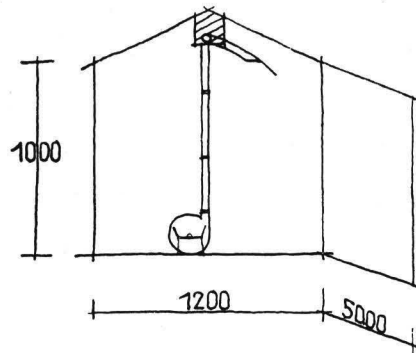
Gebläsehäcksler, Zerreißer und andere. Möglichst stationär an gut zugänglicher Abladestelle unter Dach. Förderung erst hoch, dann waagrecht. Flache Dachneigung besser als steile, hohe Gebäude. Festverlegte Leitung mit Bedienungsgang zweckmäßig. Bei hoher Lagerung von Häckselgut starke Deckenbelastung. Großer Kraftbedarf
